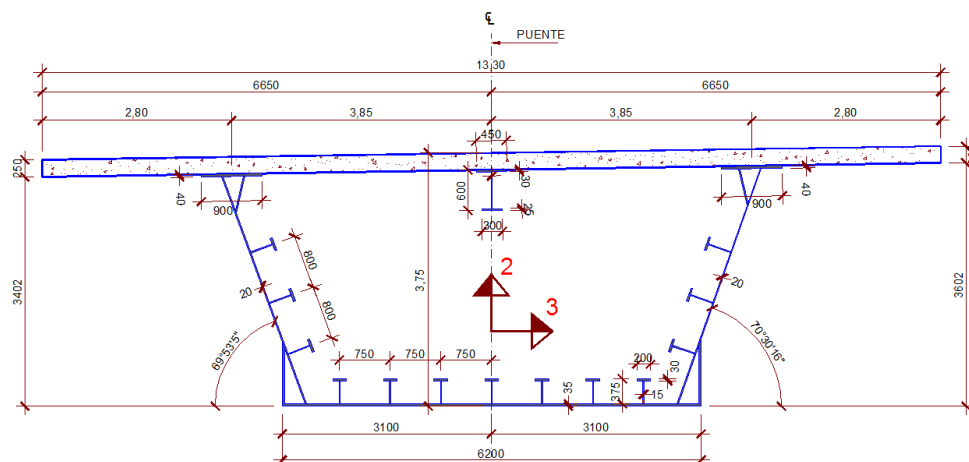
Geometría de la sección transversal del puente en tramo central (Fuente: Elaboración propia)
